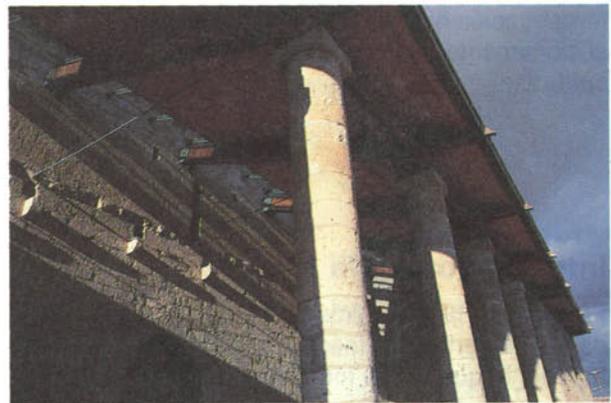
b.—Nueva cubierta del atrio: Vista del interior.
